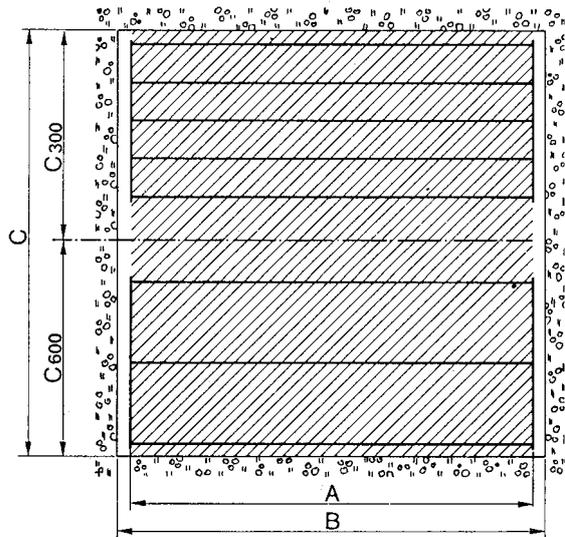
Beheizte Decke mit Rohrabständen von 300 und 600 mm
